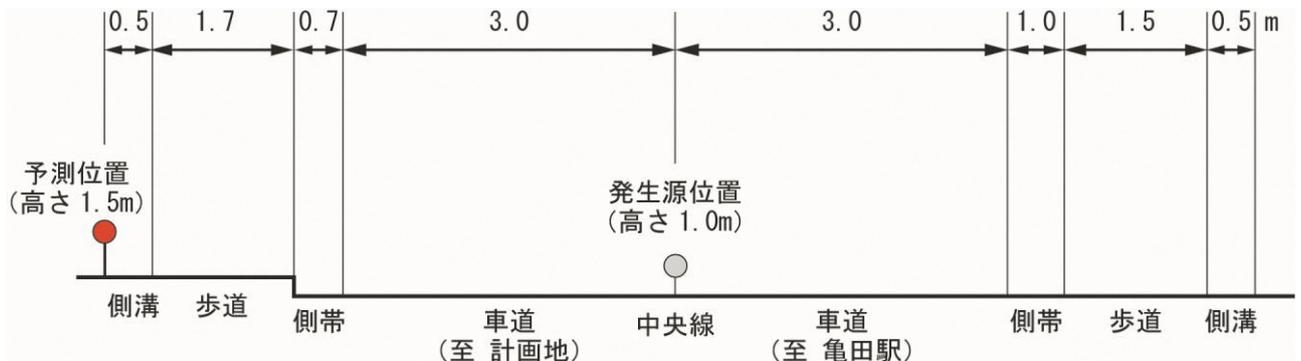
(6) 道路断面図 (No. 6 : 新潟新津線沿道)
